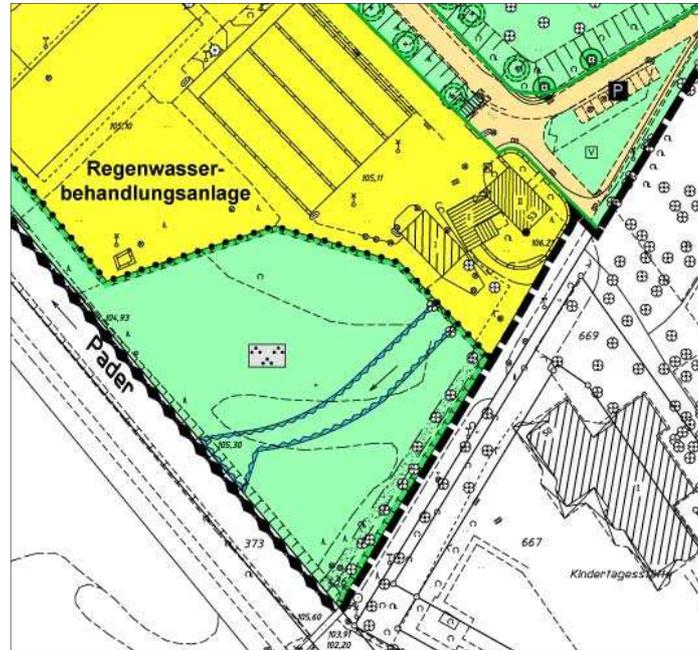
Bereich des Auslaufbauwerkes und der Leitungstrasse
